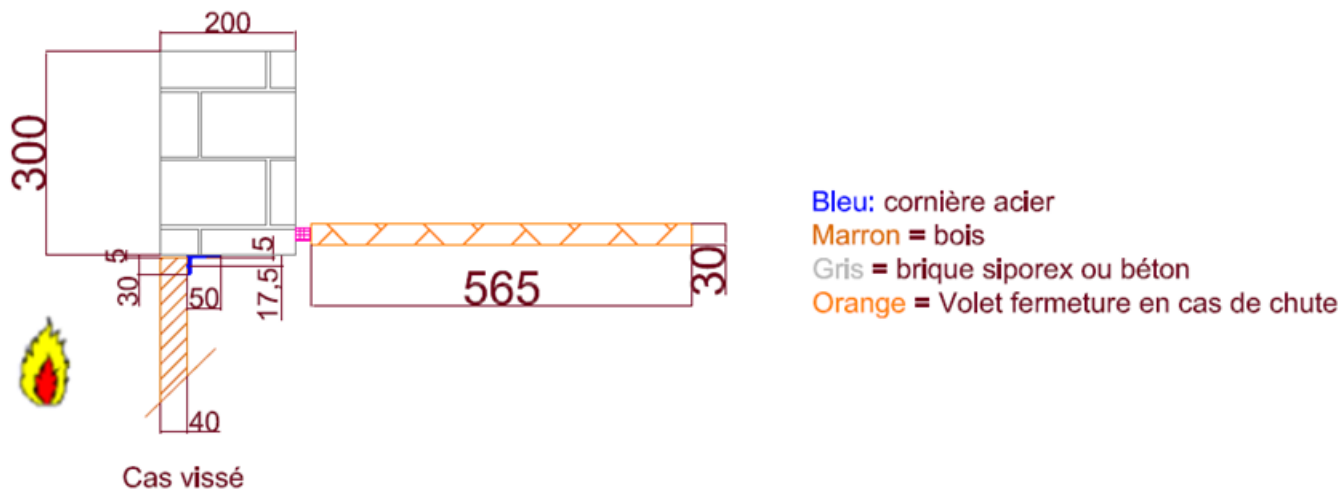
Plan de montage pour un panneau fixé sur cornières.
